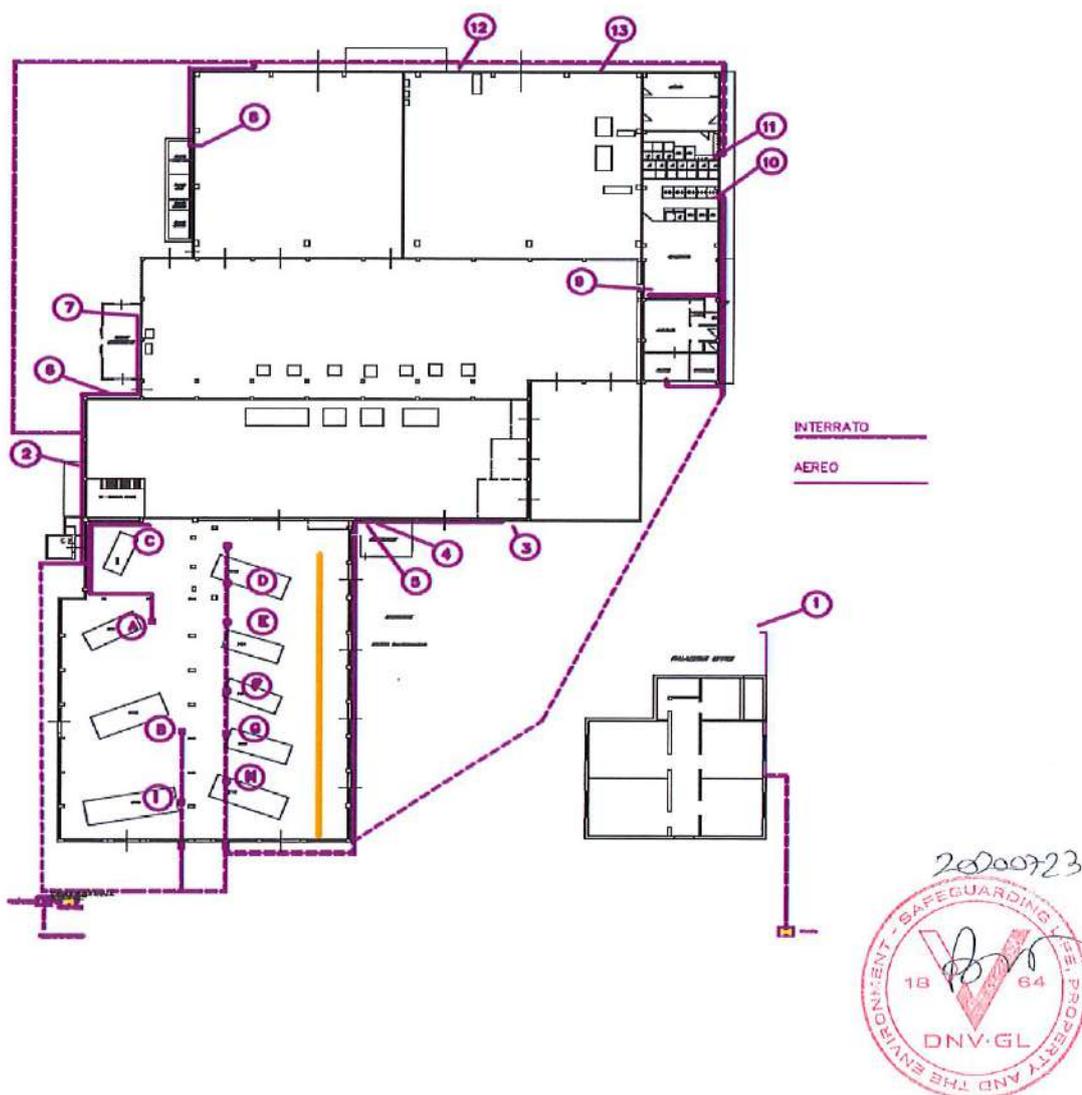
PLANIMETRIA IMPIANTI TERMICI
